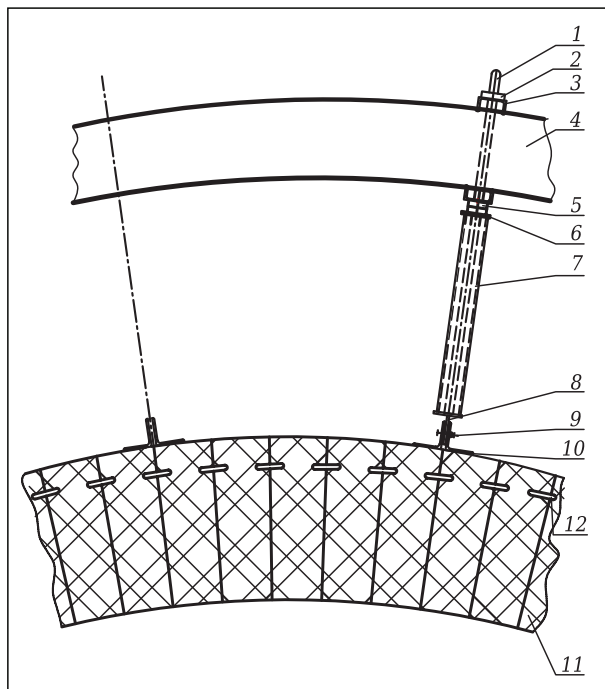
Продольный разрез крепления свода подвесками: 1 — тяга; 2 — клин; 3 — швеллер; 4 — несущие дуги; 5 — прокладка; 6 — шайба; 7 — трубка; 8 — подвесная пластина; 9 — болт; 10 — уголки; 11 — кирпич; 12 — штырь
